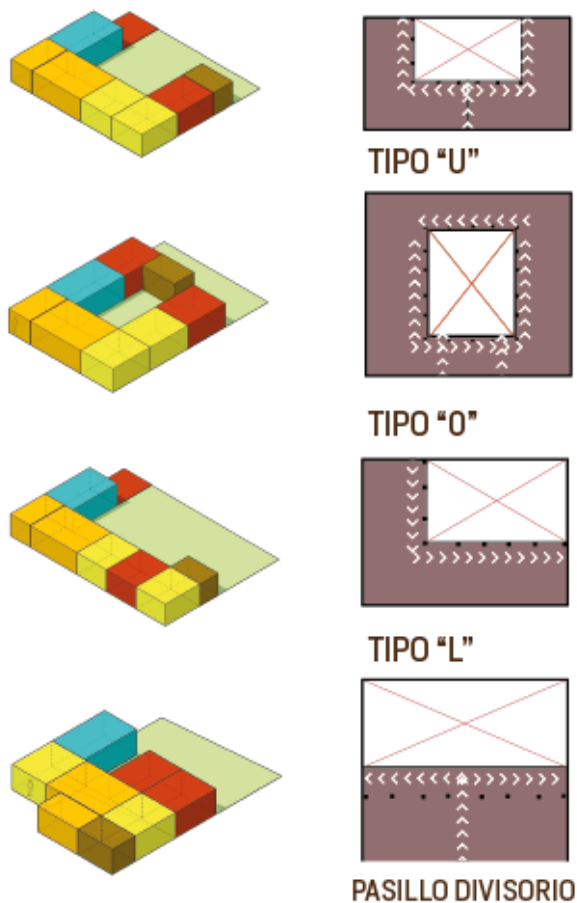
Tipologías replicables principales de la vivienda en Santander y Norte de Santander
